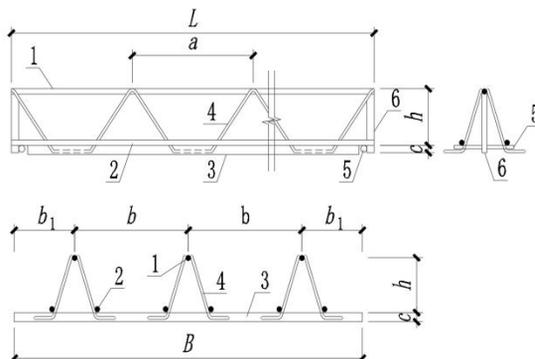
UHPC 轻型叠合板立面、剖面图
